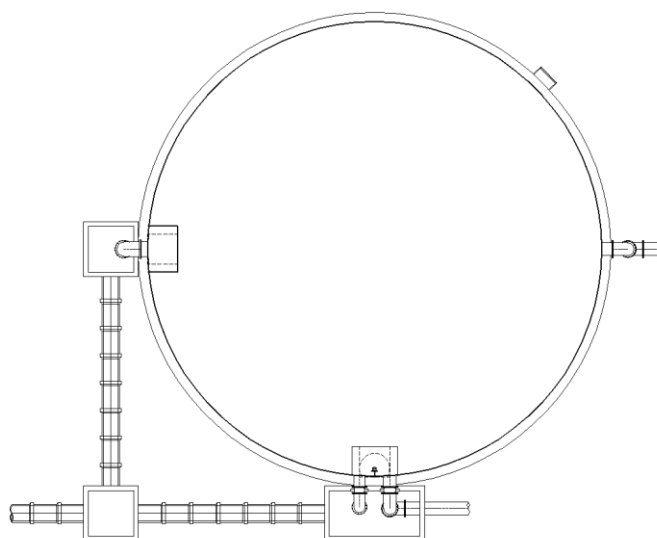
Esquema em planta do reservatório circular em chapa metálica, apoiado (Reservatório Tipo 1)
